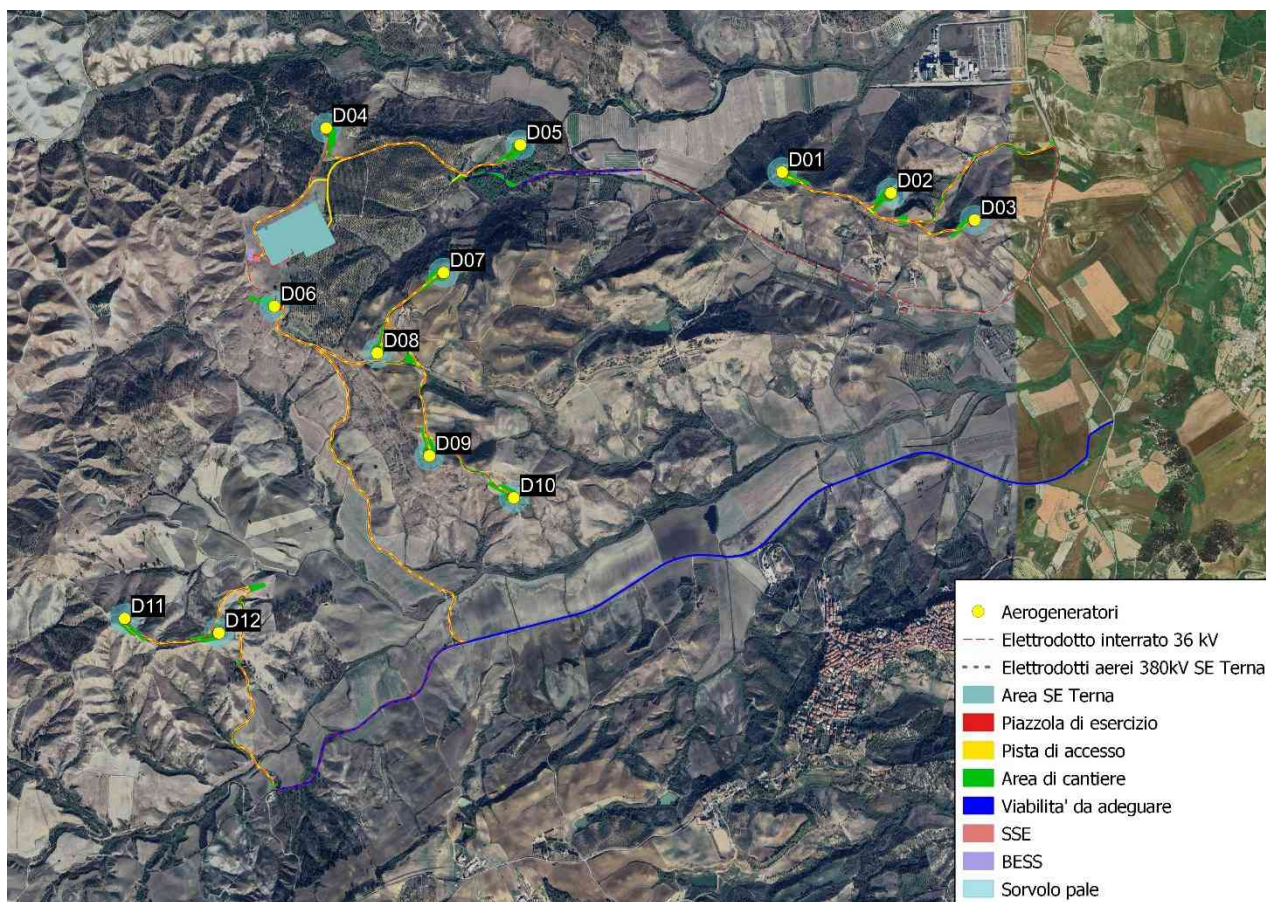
Inquadramento su base ortofoto del layout di impianto
